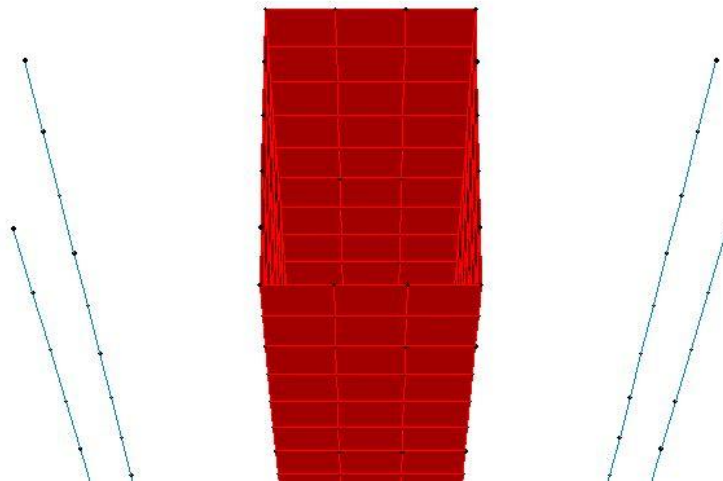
Vista em planta, a partir do 37º piso, do núcleo central sem aberturas e dos pilares laterais
